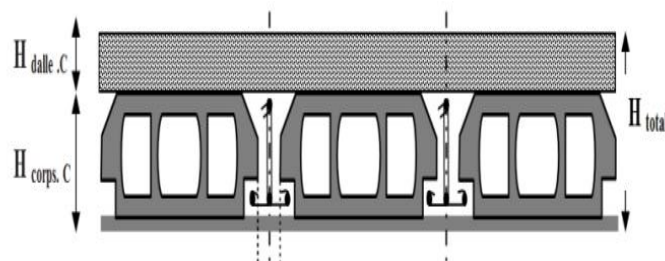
Coupe transversale sur un plancher à corps creux.
